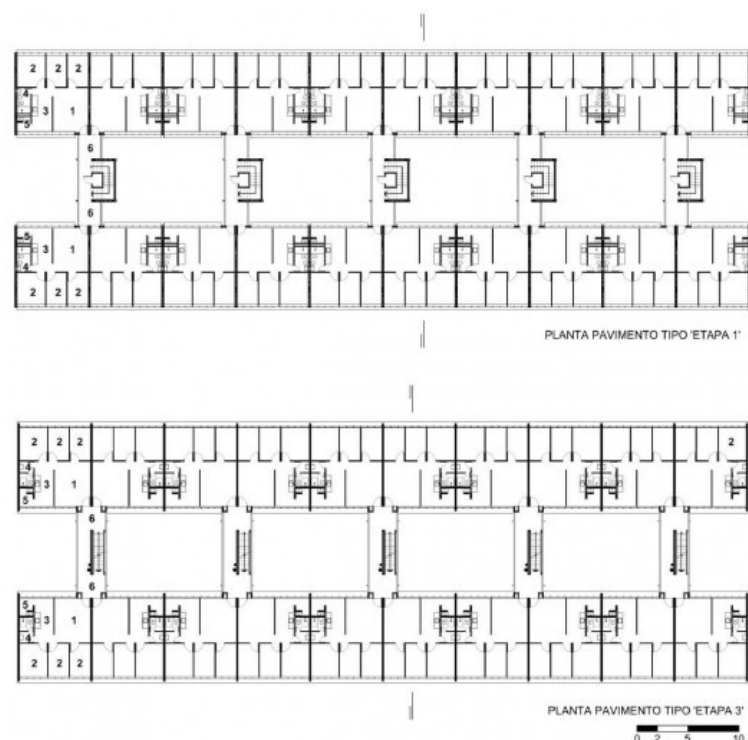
Conjunto Zezinho Prado, plantas pavimento tipo, etapa 1ª e 3ª.
